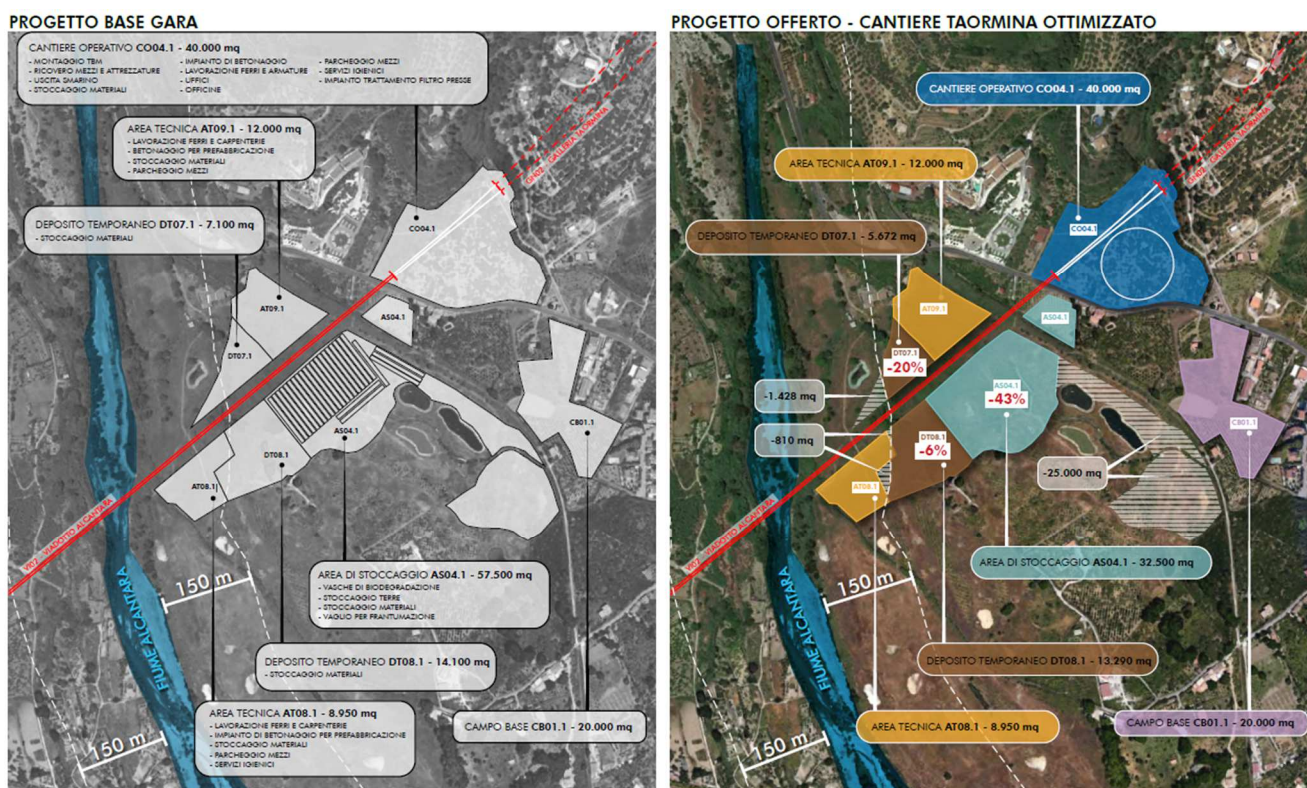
Confronto Aree di Cantiere zona Alcantara PD - PE
